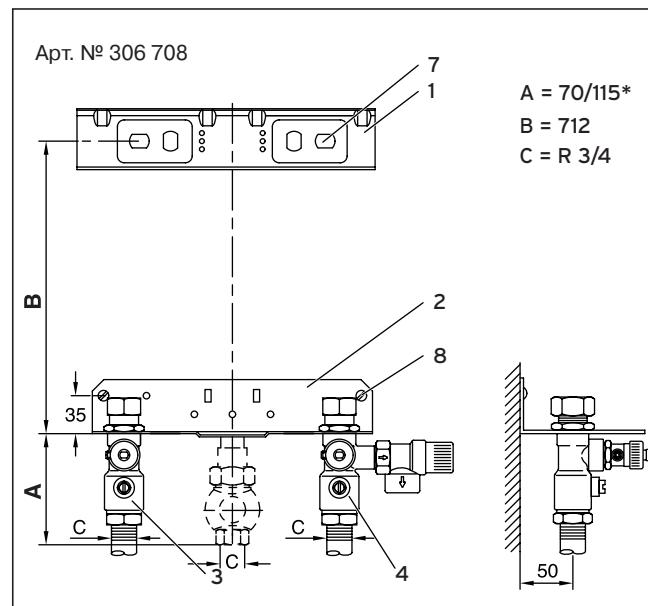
Соединительная консоль VU (открытый монтаж)
